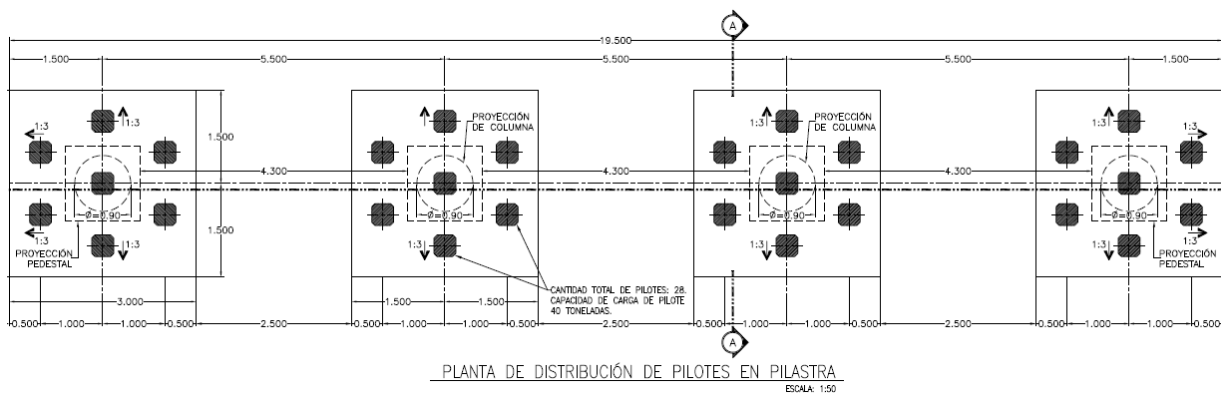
Planta de Distribución de Pilotes en Pilastra.
